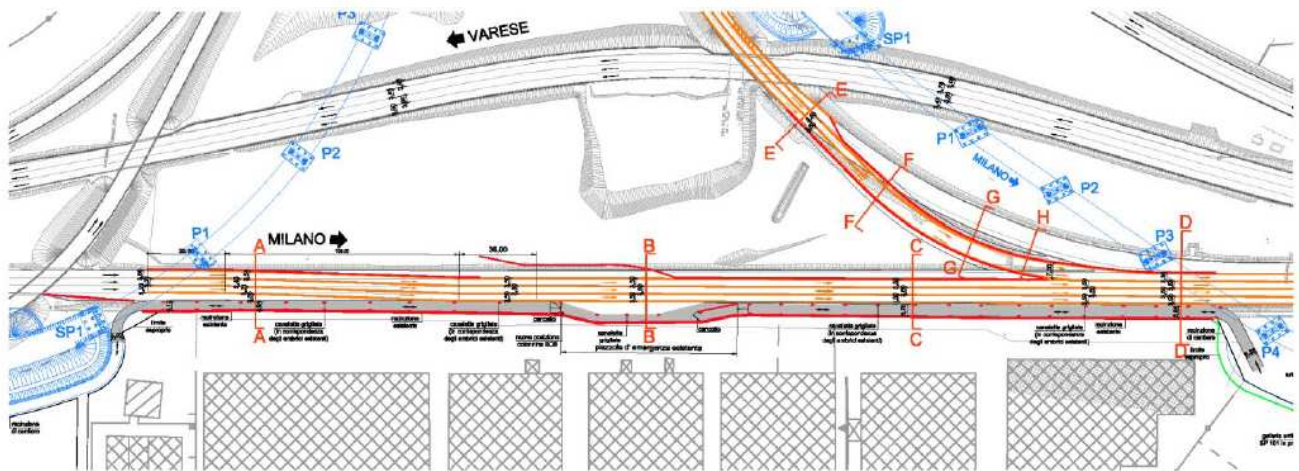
Stralcio planimetrico pista di emergenza Lainate
